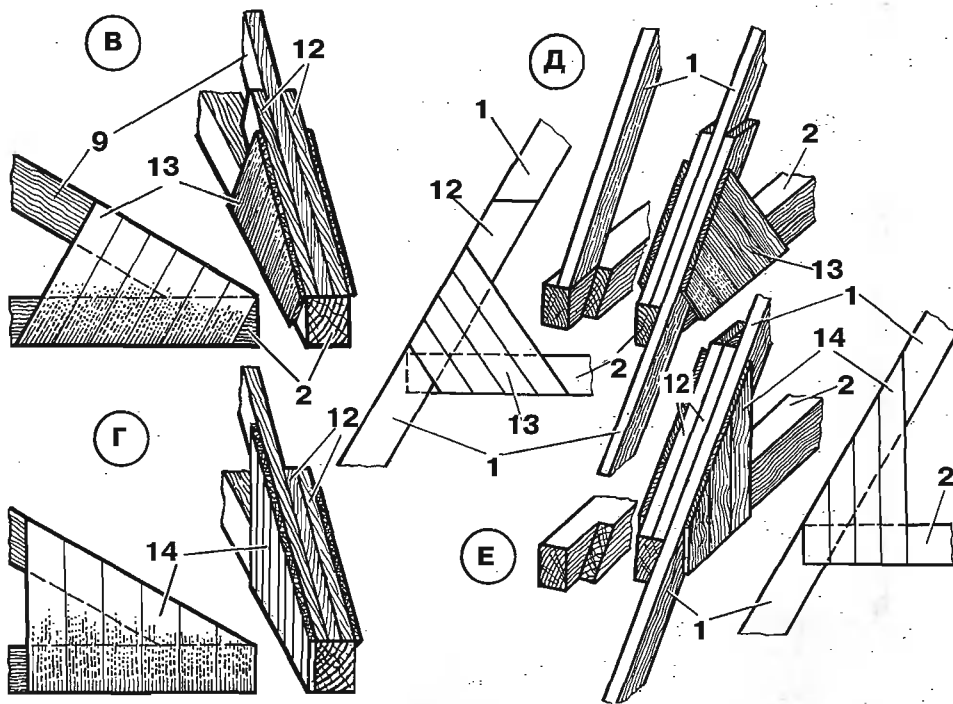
Монтаж стропил и соединение стропил с балками перекрытия:
